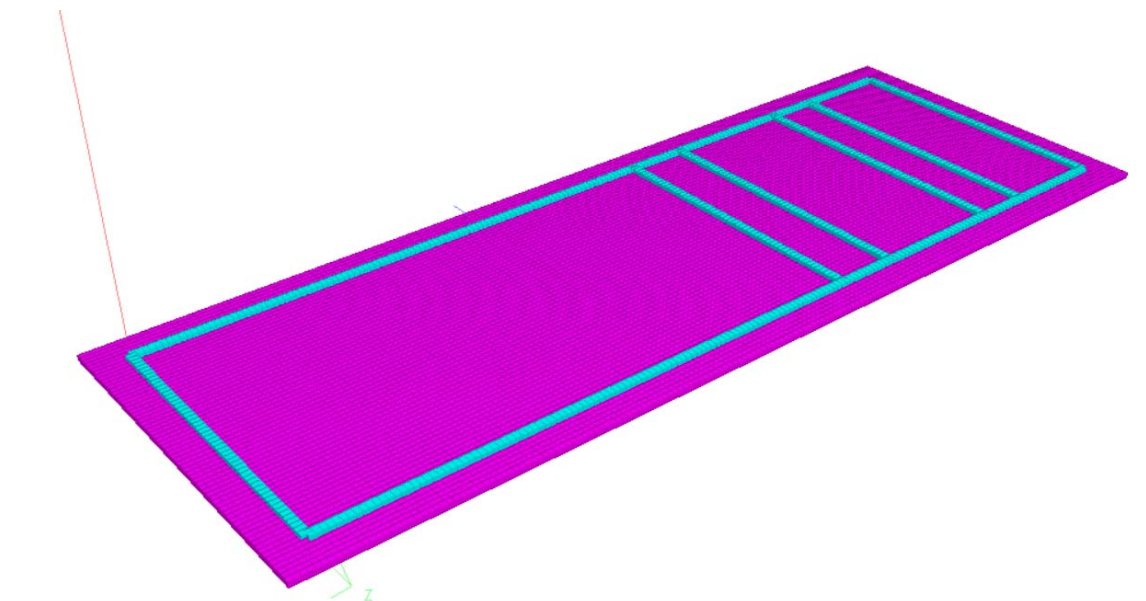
esquema de fundación: En celeste las vigas; en violeta la platea
